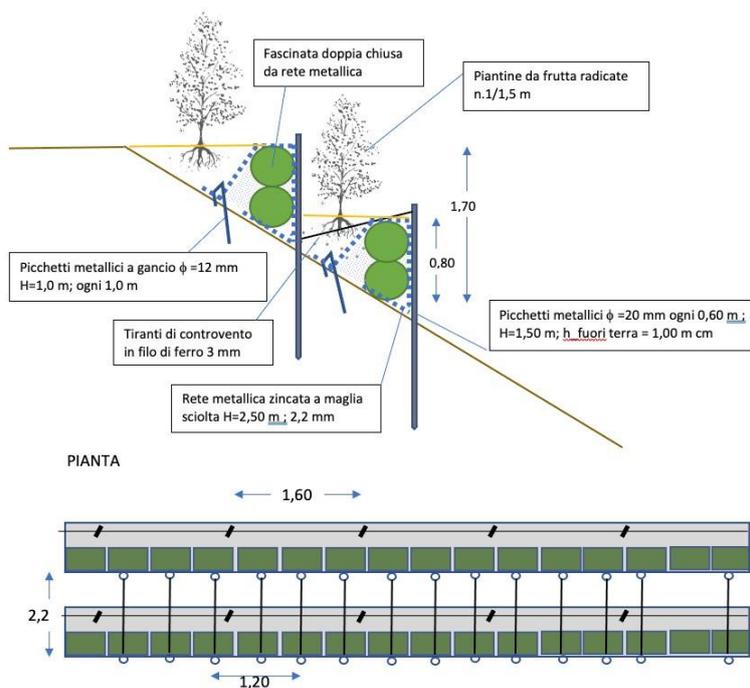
Schema di sezione tipo e pianta prototipo B1.
